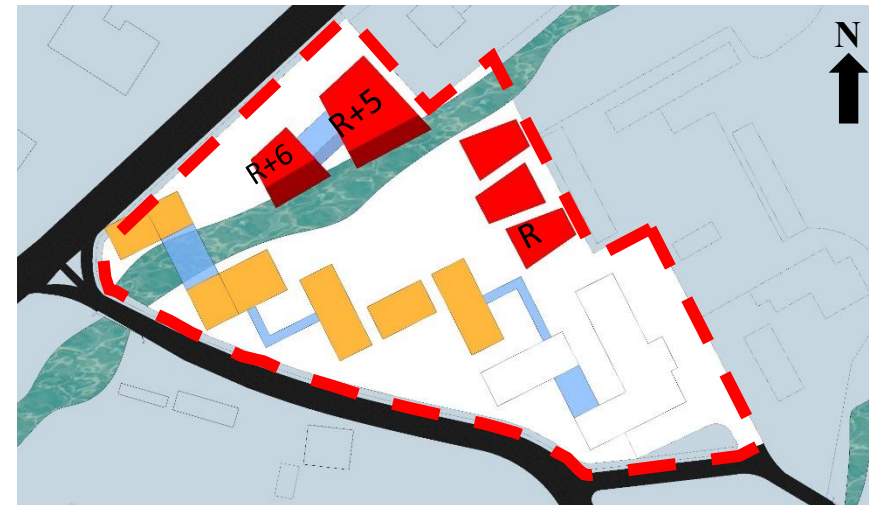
Satisfaction des exigences fonctionnelles. Vue en plan.
